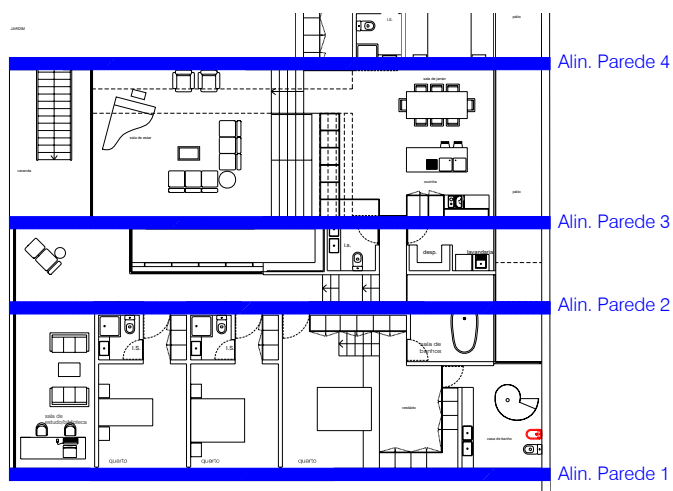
Planta do piso 0 com indicação dos alinhamentos das paredes estruturais.
